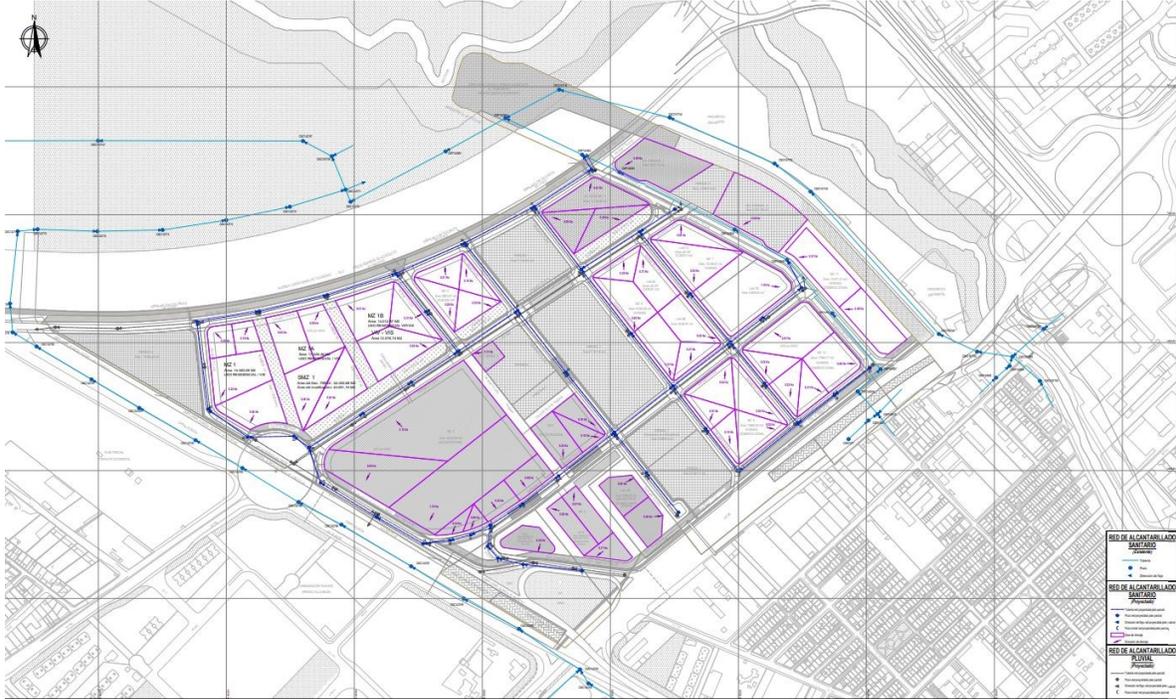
Plano de la red proyectada de alcantarillado sanitario PPD – Áreas de drenaje
